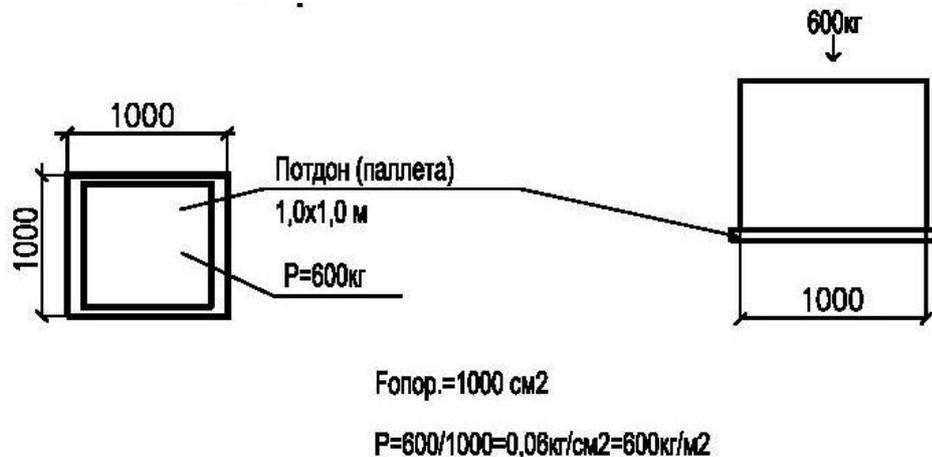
Расчет нагрузки на перекрытие от складирование легкобетонных блоков.
